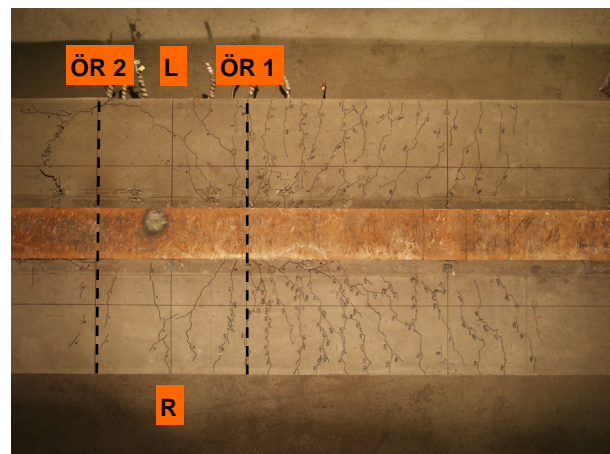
Rissbild auf der Betongurtunterseite
